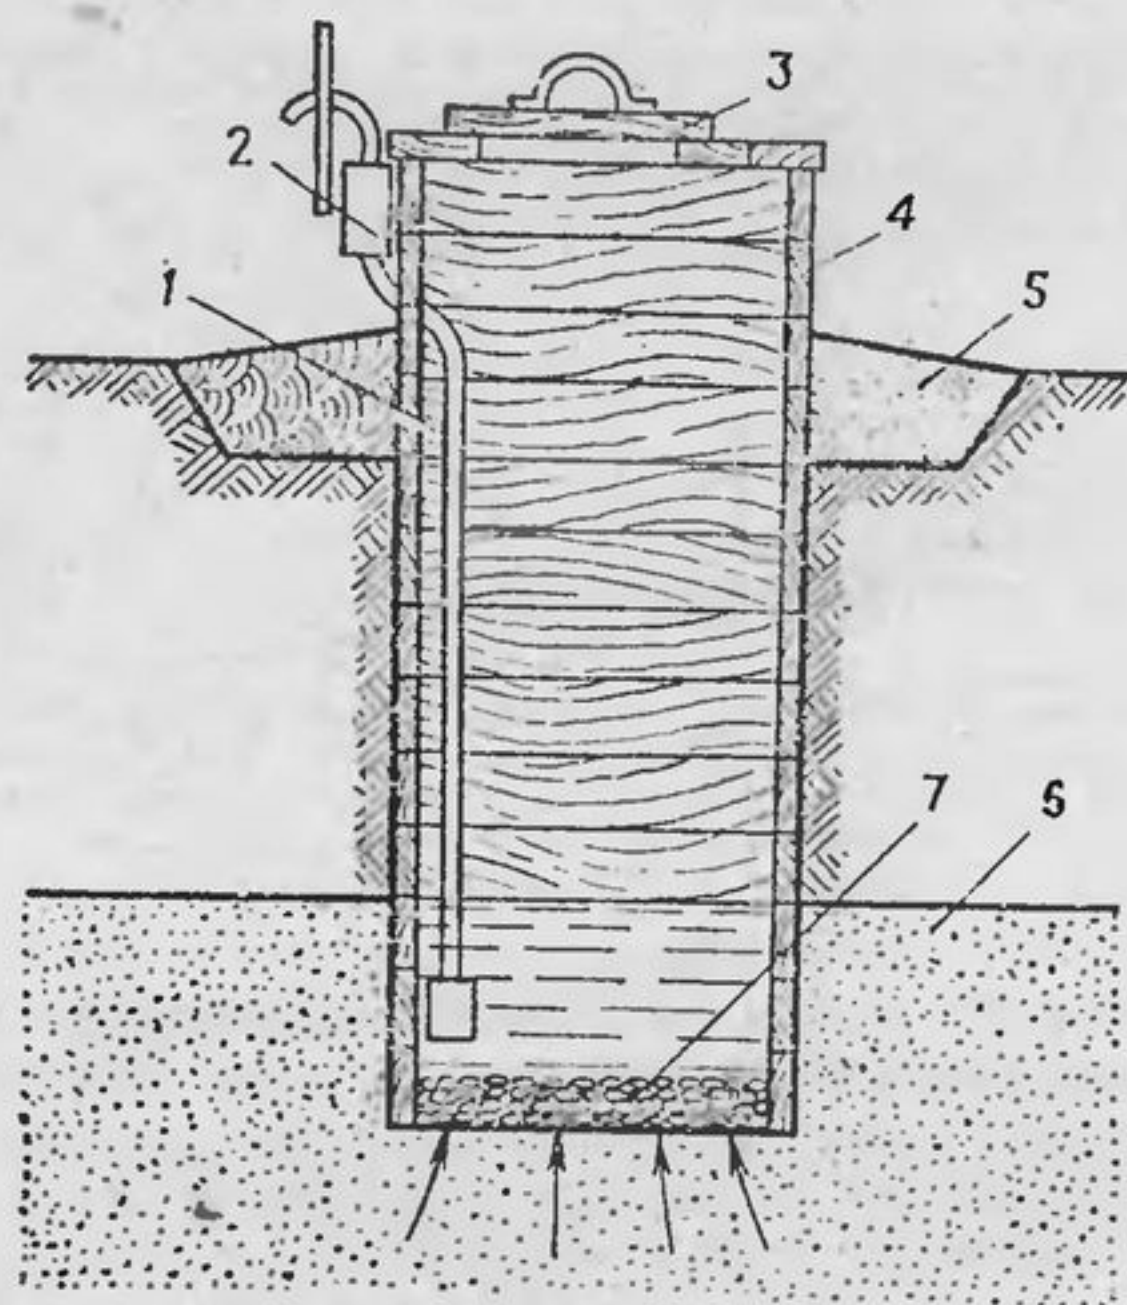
Шахтный колодец с креплением стенок дощатыми щитами:
